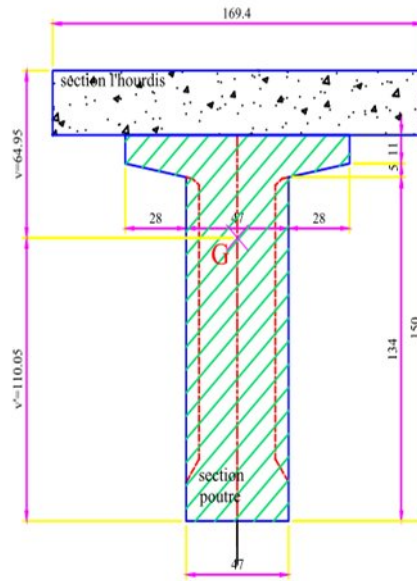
les dimensions de la section de la poutre+l'hourdis à l'bout
